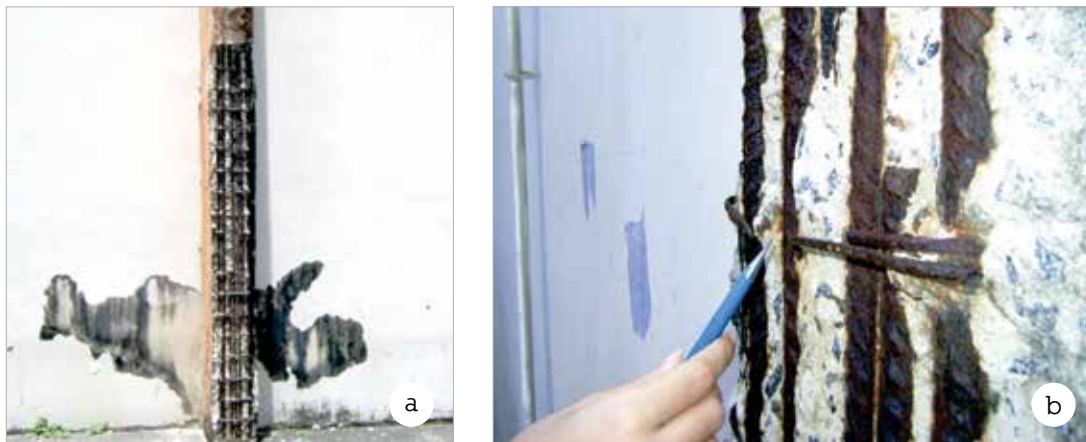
(a) Pilar apresentando armaduras expostas e (b) estribos rompidos
